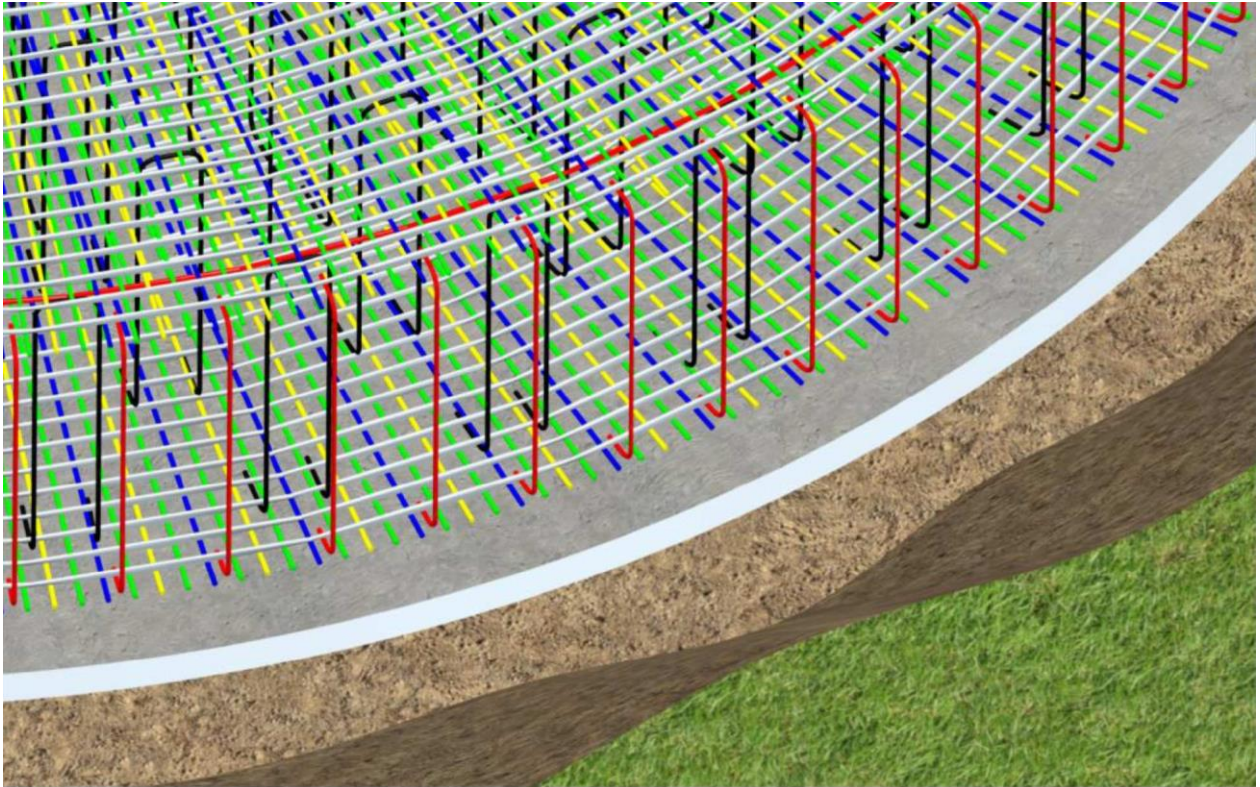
An der Außenkante montierte Randbewehrung
